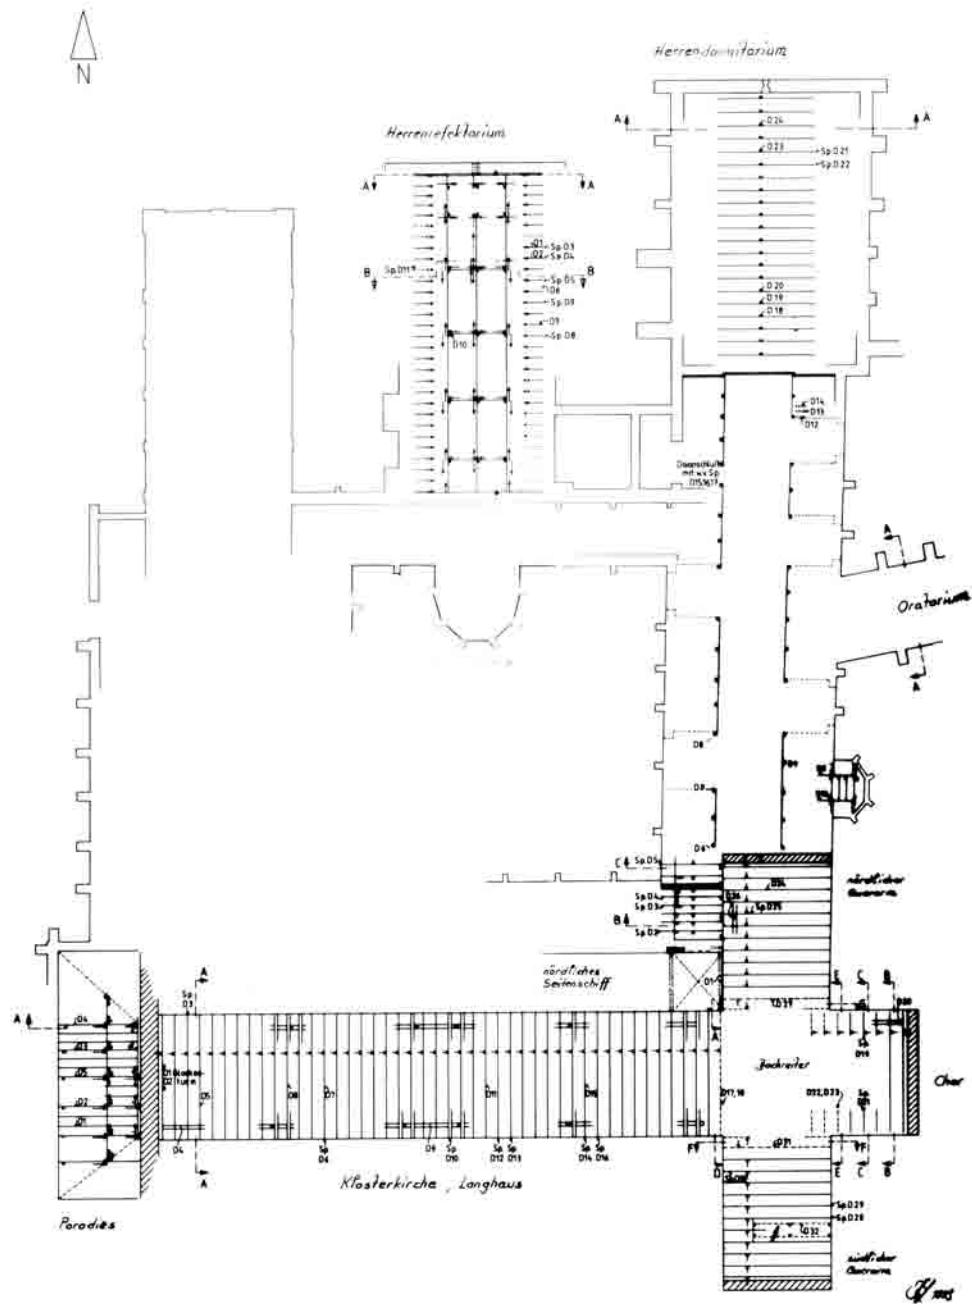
Kloster Maulbronn, Übersicht Klausur. Systemdarstellung der untersuchten Dachwerke im Grundriss mit Eintragung der untersuchten Bauhölzer und Lage der Dachschnitte.
